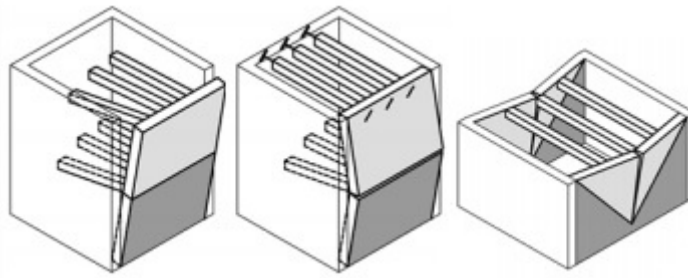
Derrube das paredes transversais provado pelo movimento independente dos sistemas estruturais dos pavimentos (Piazza et al., 2008)
